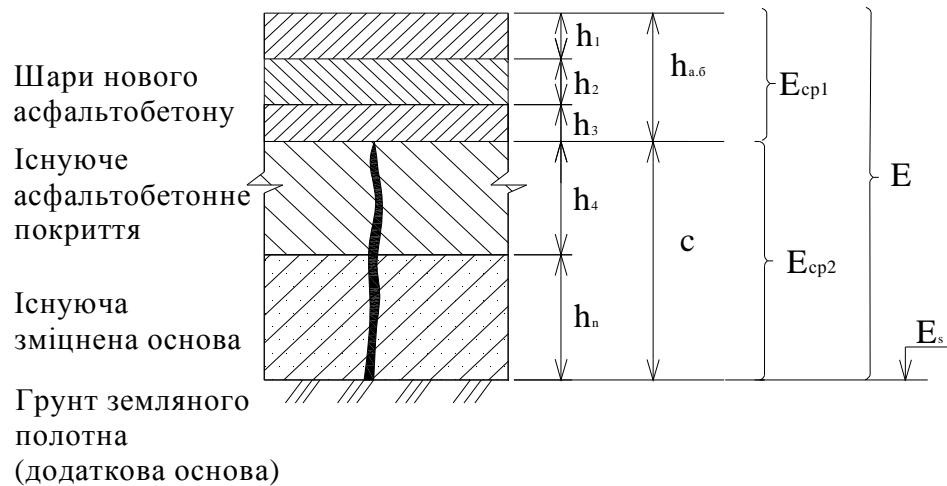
Схема конструкції дорожнього одягу з існуючим покриттям з асфальтобетону на тріщинувато-блочній основі, укріпленій цементом
